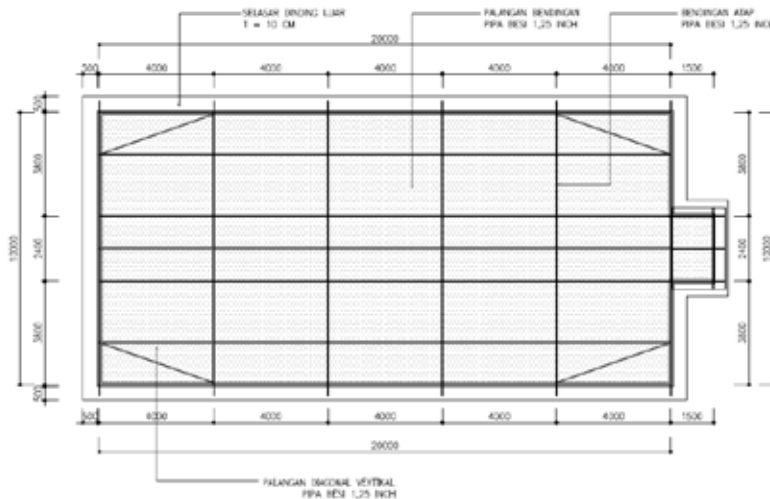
Tampak Atap Berventilasi pada Bangunan *Green House* Florikultura dengan Standar Luas 200 m² (Dimensi 10 m x 20 m)
